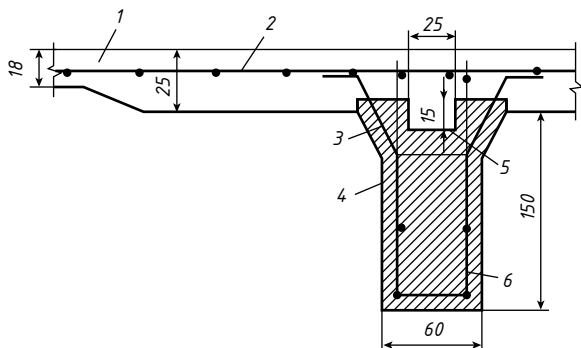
Деталь сопряжения анкера с плитой покрытия:
